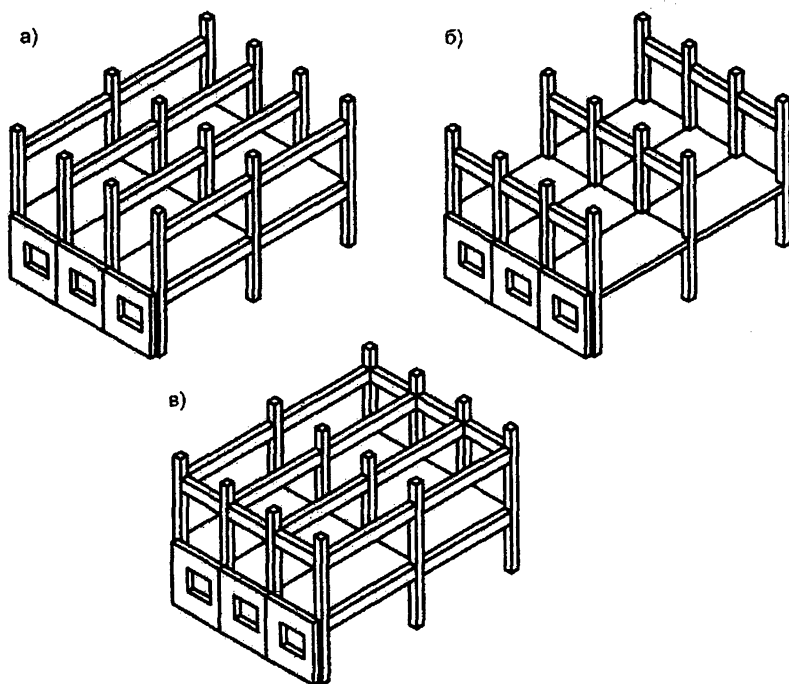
Схемы каркасных крупнопанельных зданий:
